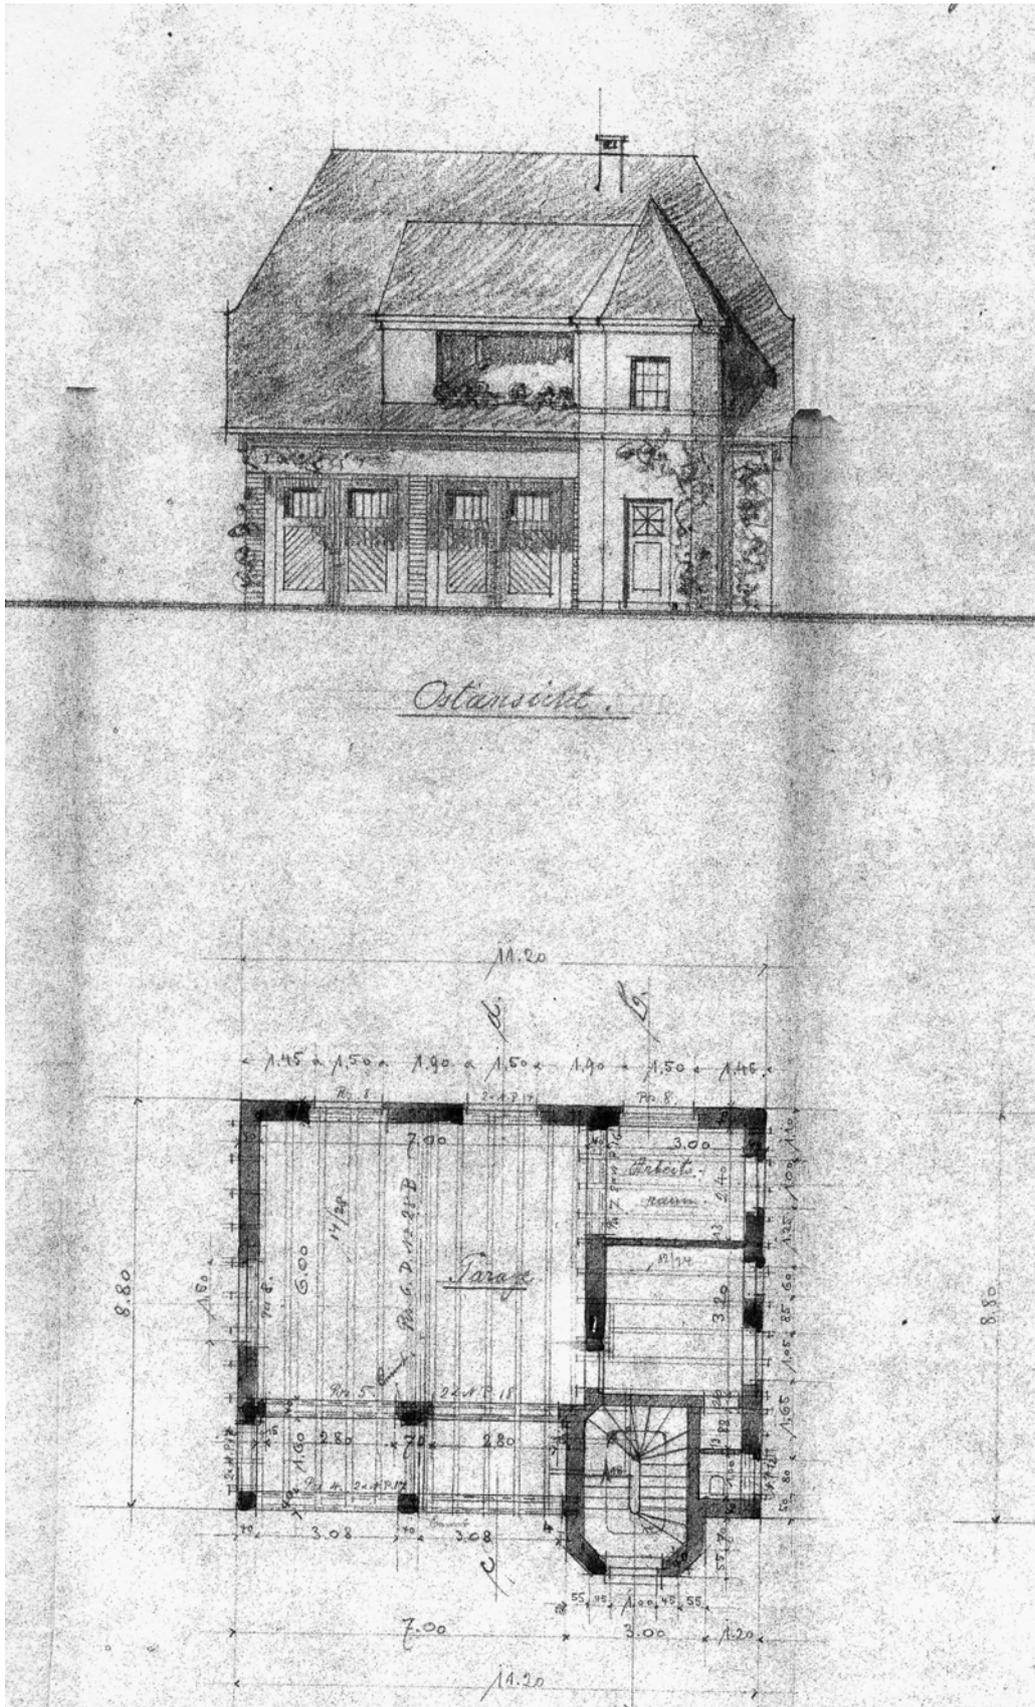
H. Plange, nicht ausgeführter Entwurf des Chauffeur- und Garagenhauses, Aufriss der Ostansicht und Grundriss des Erdgeschosses, 1913
